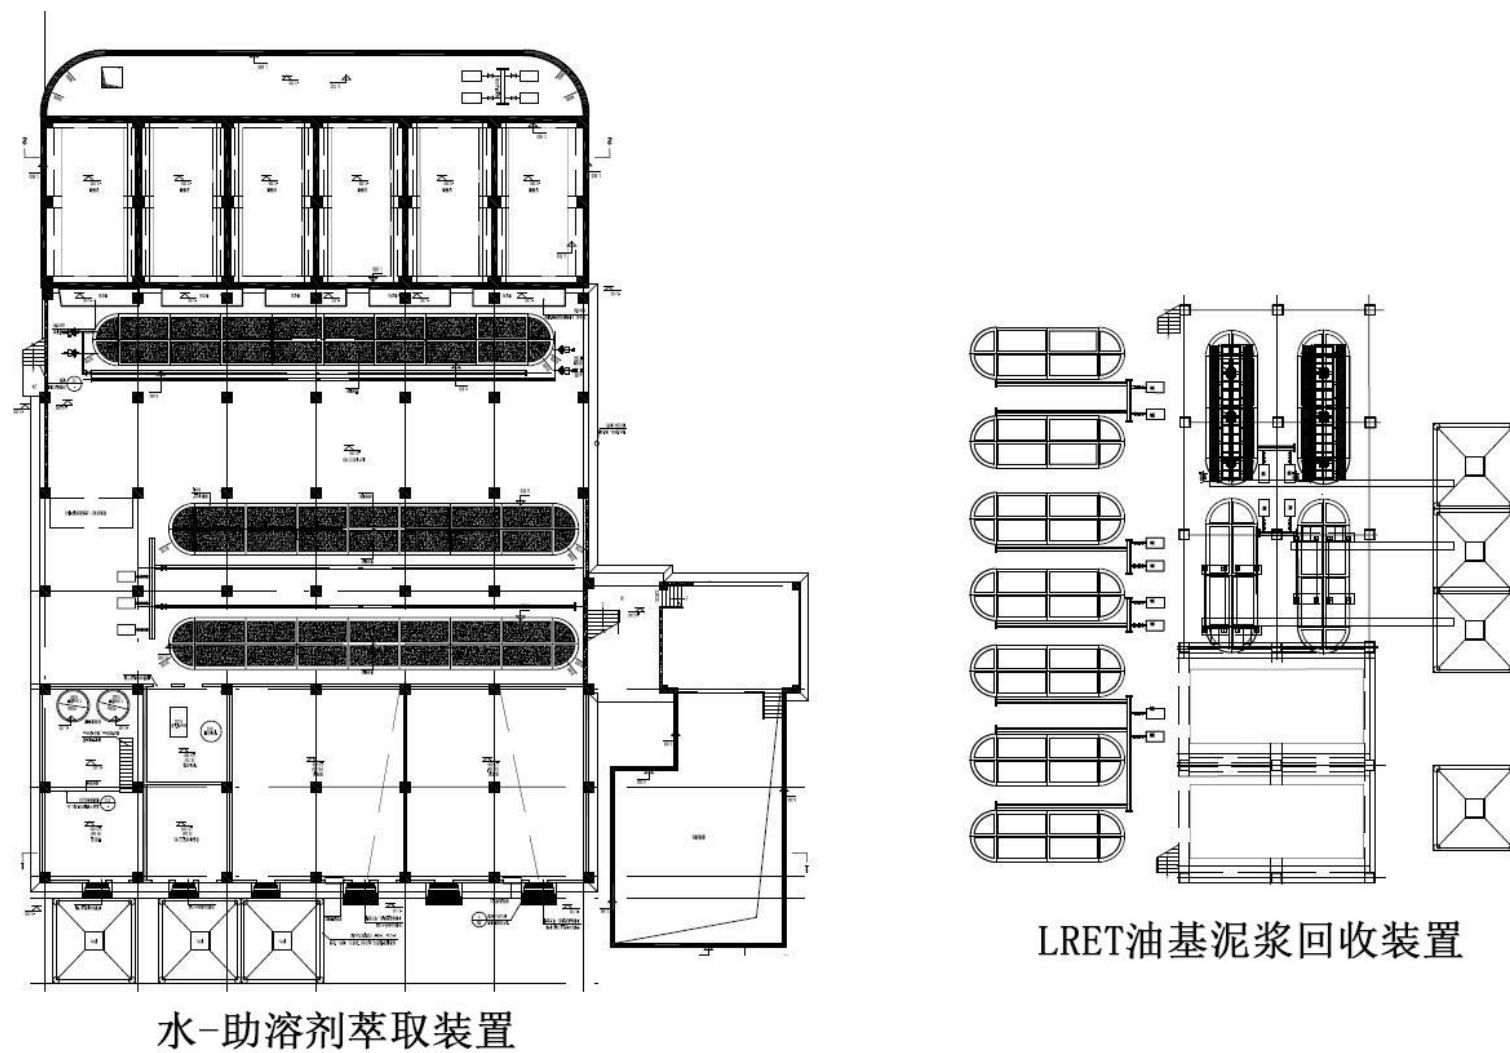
水-助溶剂萃取及 LRET 装置平面布置图
